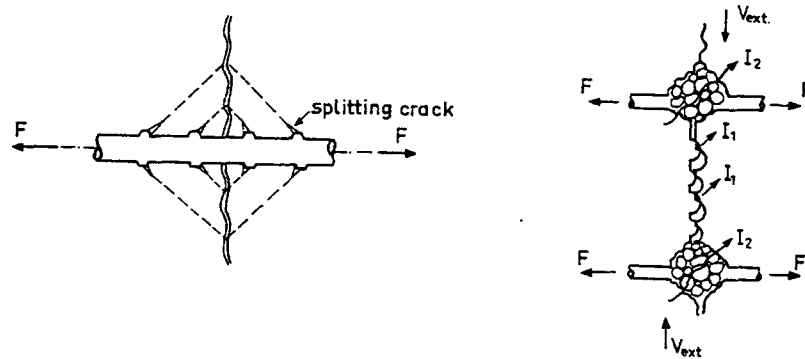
Lokale Schädigung des Betons im Bereich eines Risses am Bewehrungsstab
